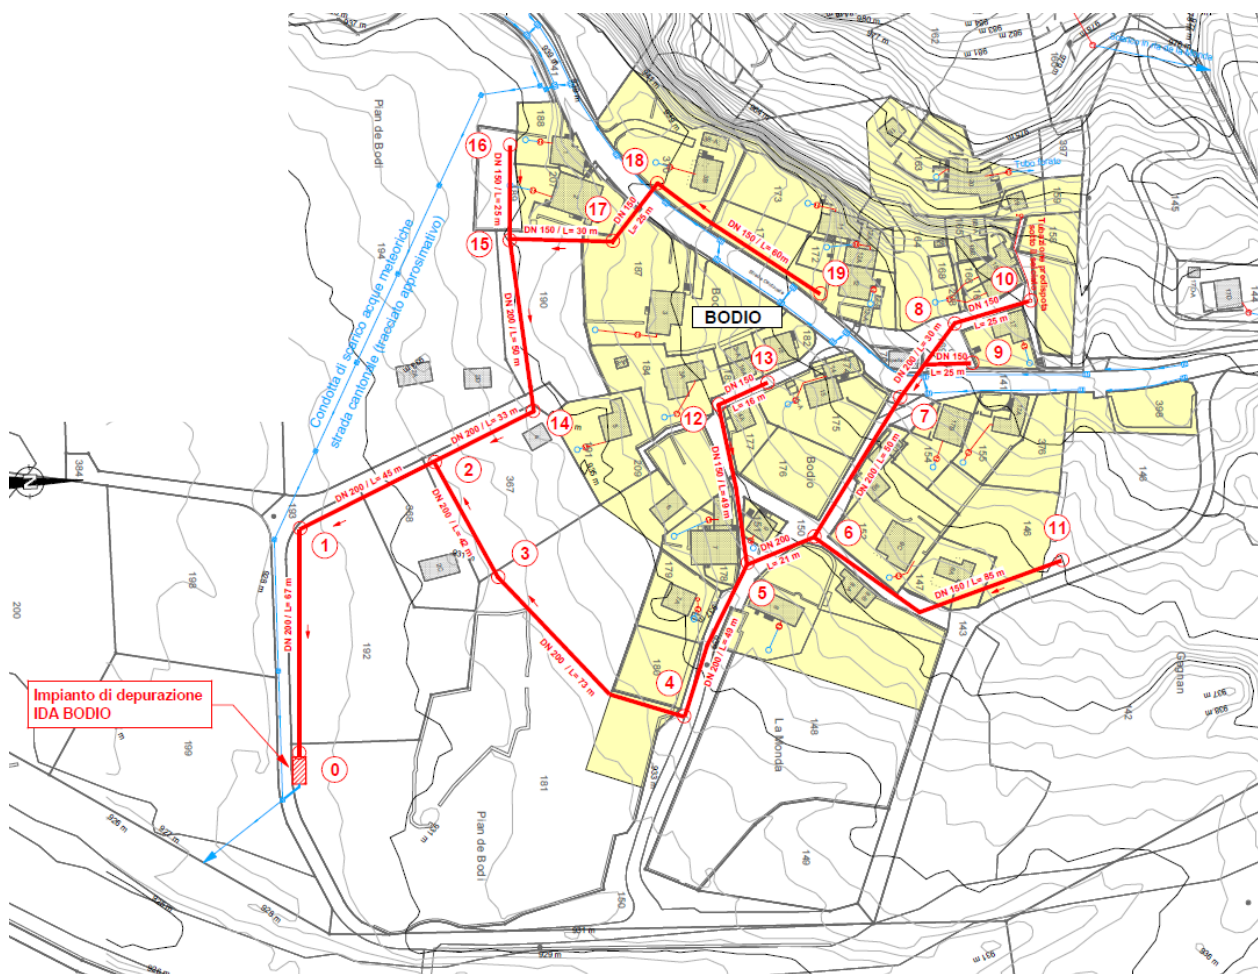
Estratto planimetrico del PGS, progetto preliminare, Giudicetti e Baumann SA, 2015
